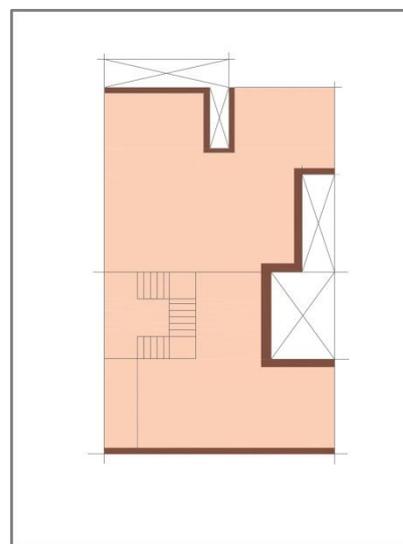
En naranja superficie construida, Sc: área de la parcela menos el área descubierta. En marrón perímetro construido, el enfrenta al exterior. Fuente: autora.
